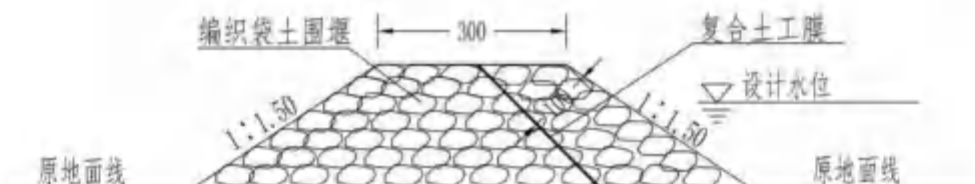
穿堤涵闸进出口临时围堰典型断面图 (单位: cm)
